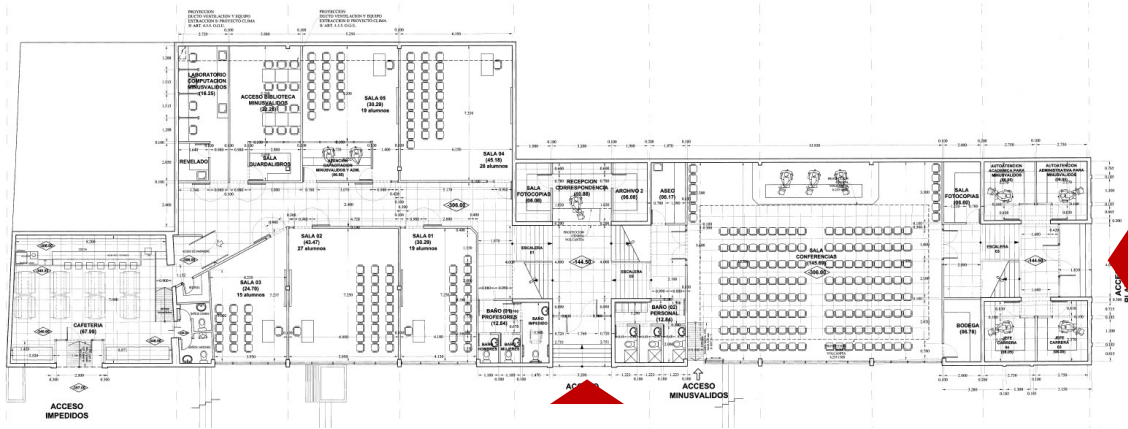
Planta arquitectónica del Primer piso: 726 m²
